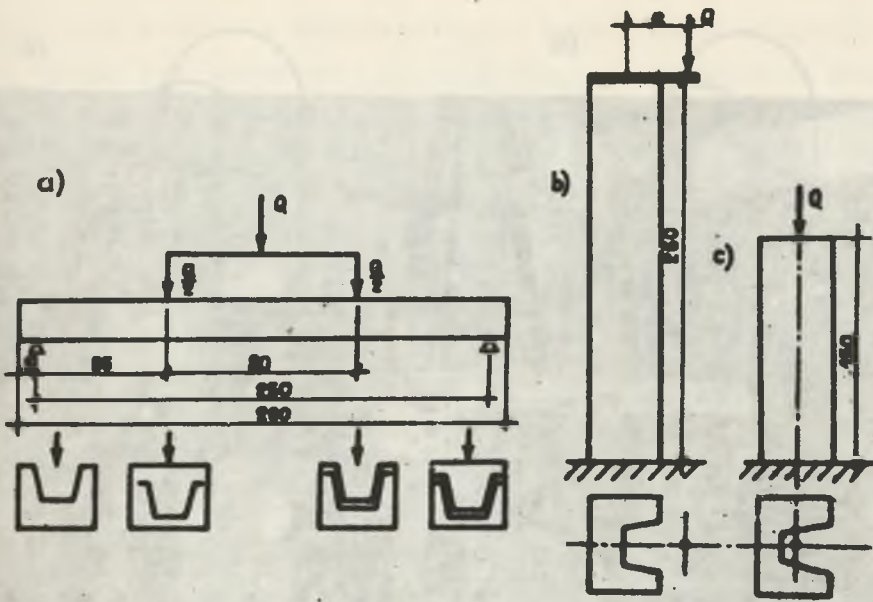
Przekroje poprzeczne oraz gabaryty zewnętrzne przyjętych do badań konstrukcji stalowo-betonowych elementów serii A - D
